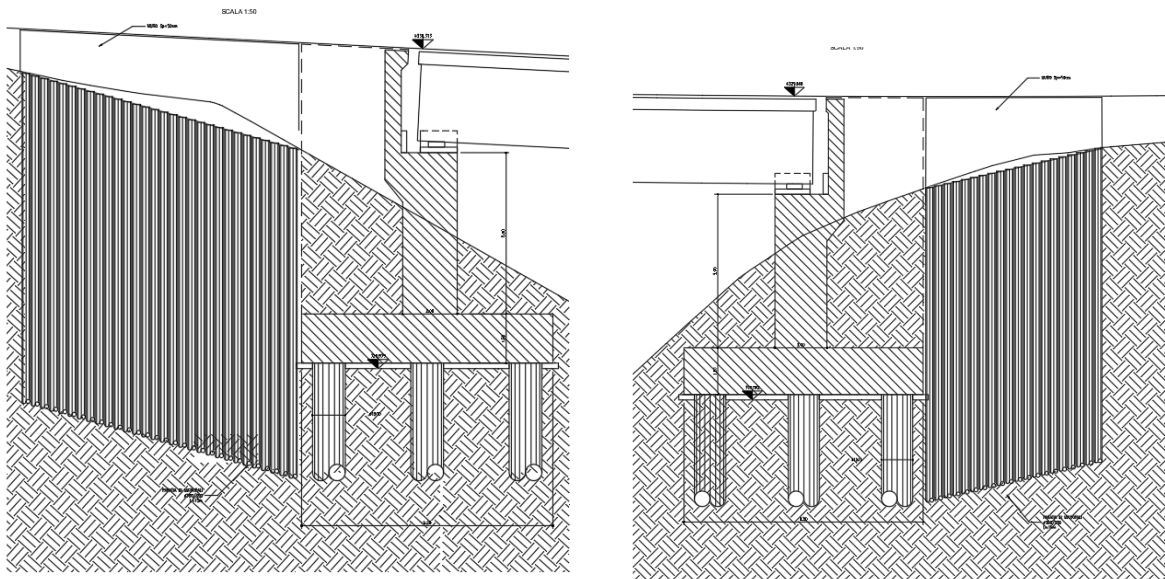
Muri di appoggio Spalla A e Spalla B
